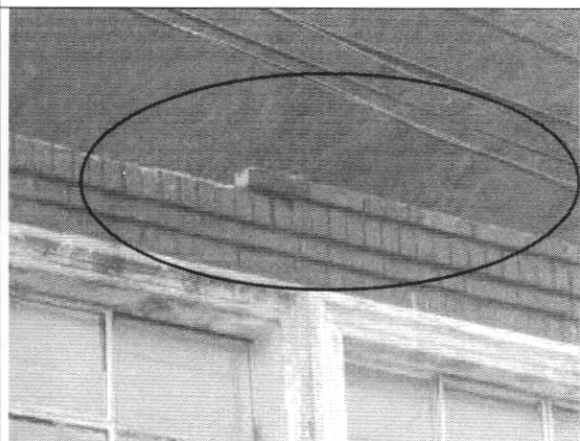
Desprendimiento de unidades de mampostería, parte superior del muro
